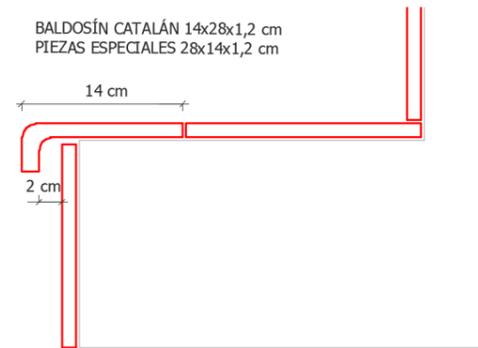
Detalle colocación acabado. 2018. Elaboración propia
